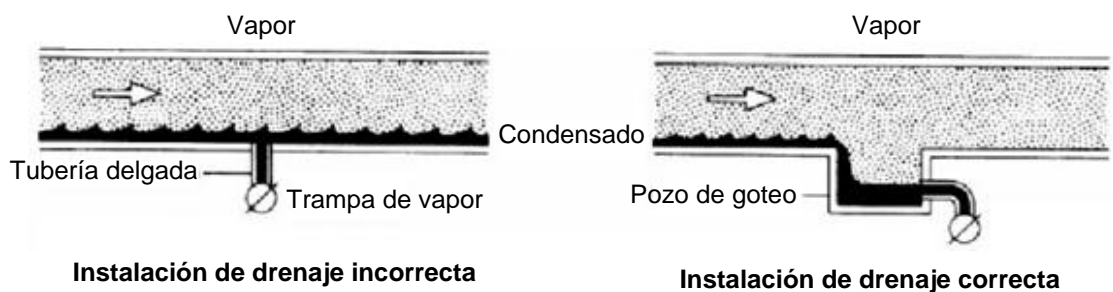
Configuración correcta para un sistema de drenaje de condensado
